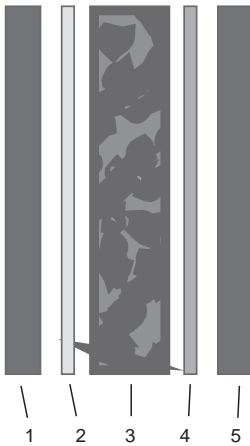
Слои изоляции в двери для парилки: 1 — обшивная доска из мягких пород древесины; 2 — лист фольги (пароизоляция); 3 — минеральная вата (теплоизоляция); 4 — лист пергамина (гидроизоляция); 5 — обшивная доска из любых пород строительной и отделочной древесины
